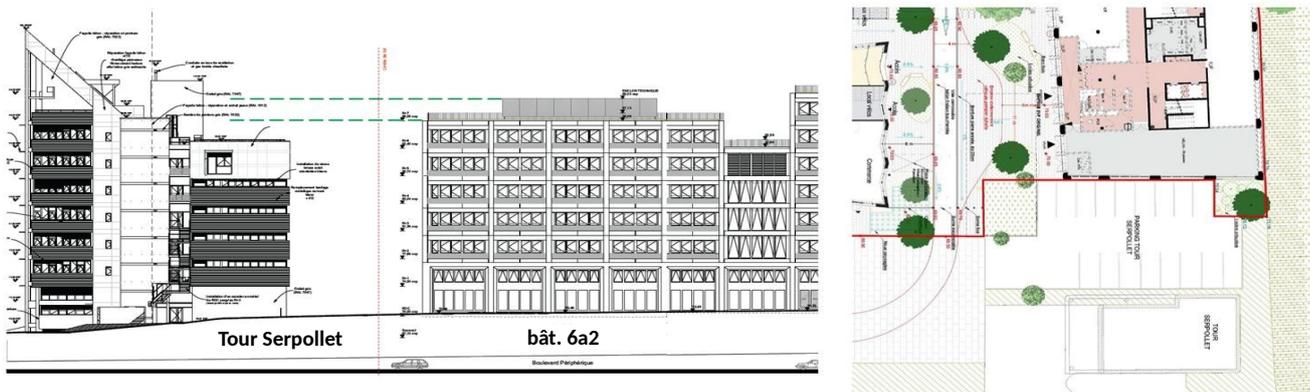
Extrait des façades est le long du boulevard périphérique qui montre la différence de hauteur entre le sud du bâtiment 6a2 et le volume nord de la tour Serpollet (source : PC05, plan des façades avec lignes de hauteur ajoutées par la MRAe) et extrait du plan du rez-de-chaussée montrant la limite du lot 6a7 qui n'inclut pas l'espace libre (parking) entre le bâtiment 6a2 et la tour Serpollet (source : PC02.2)
